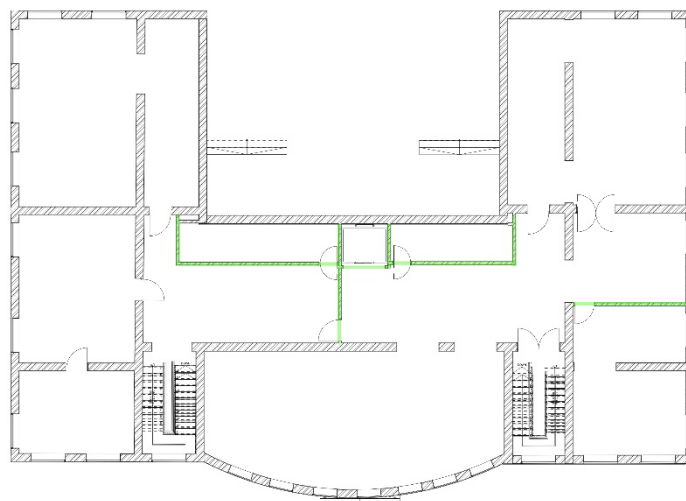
Монтаж конструкцій план на відмітці +3300 мм
